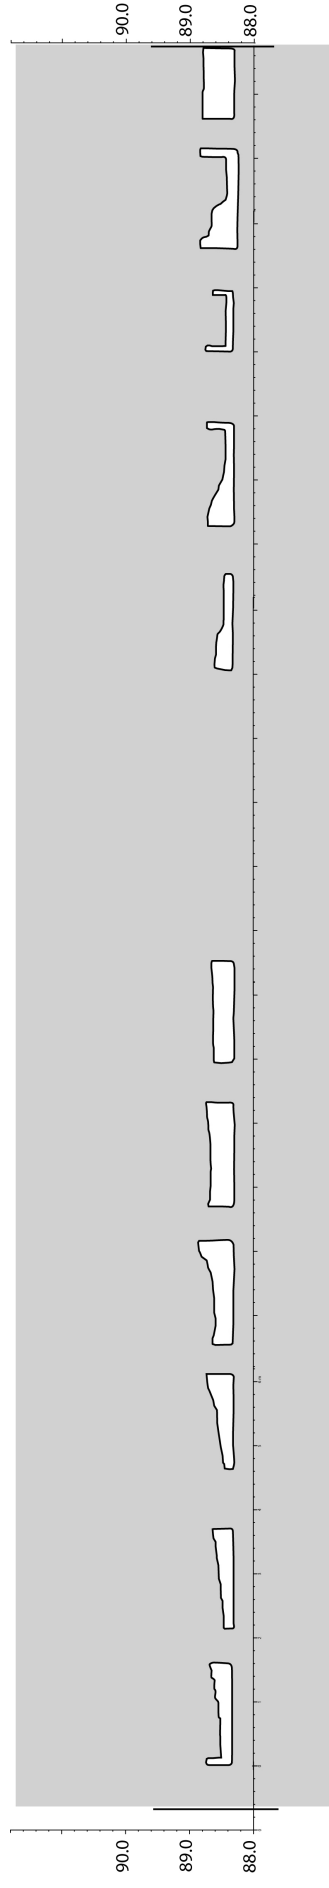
Ala sul do criptopórtico: Levantamento das pias encastradas no alçado norte.
